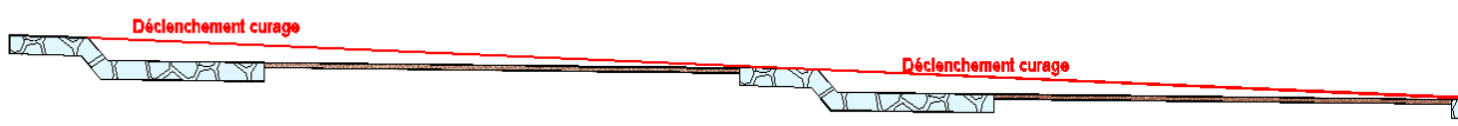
Profil en long - Piège à matériaux - Déclenchement du curage
